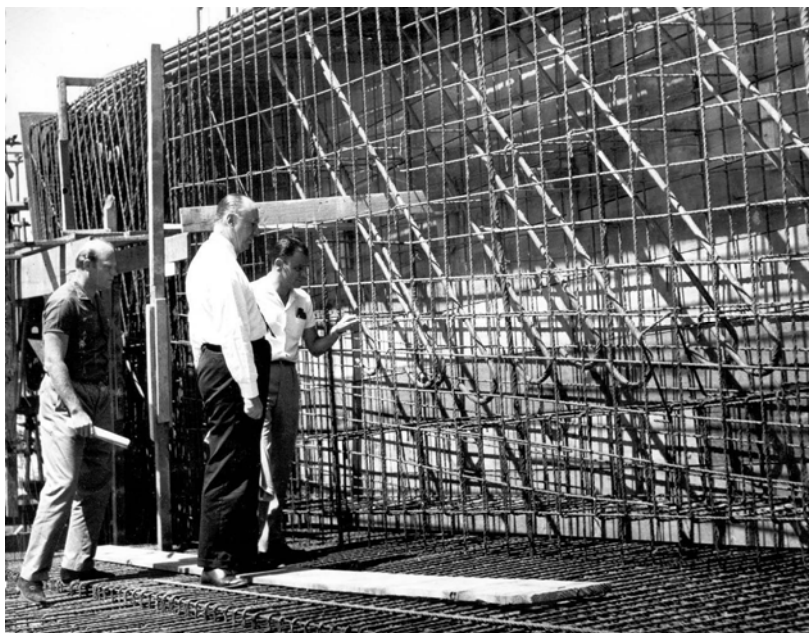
Armação da região da ligação entre o pilar externo e a viga da cobertura
